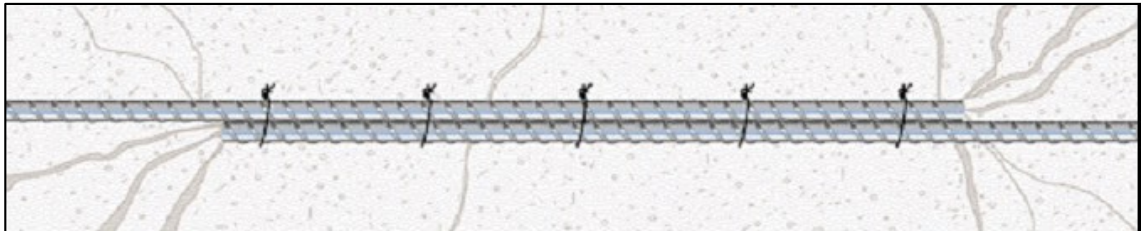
Detalhe da emenda por traspasse de barras tracionadas.
